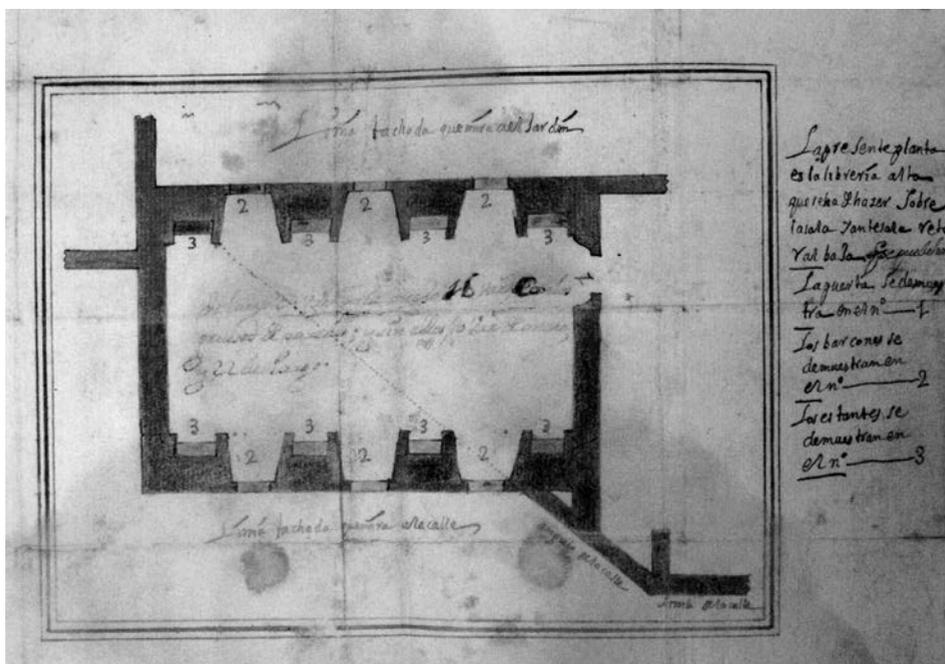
Planta de la biblioteca*. Colegio de Santa María de Jesús, obra de la librería, años 1742-1765. AHUS. legajo 609-21a. La leyenda del plano indica: “La presente planta es la librería alta que se ha de hacer sobre la sala y antesala retoral baja”. Por el característico chafflán a la plaza de Maese Rodrigo y los rótulos que la acompañan, que indican “línea fachada que mira a la calle” en la zona inferior del dibujo y “línea fachada que mira al jardín” en la superior, el plano permite identificar el espacio urbano y la posición del jardín del edificio. Dentro de la planta se anotan sus dimensiones: “De largo 24 varas y de ancho 16 varas con los gruesos de paredes; y sin ellos, 10 de varas de ancho, y 22 de largo”. La conversión de estas medidas al sistema métrico revela unas dimensiones interiores muy notables: 18 m x 8,40 m.
